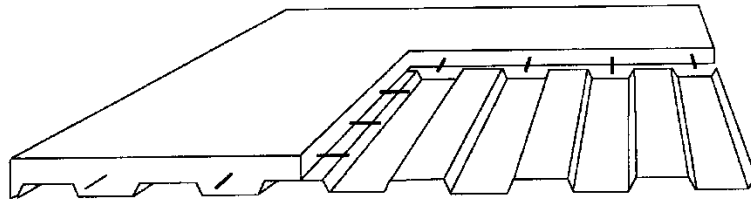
Losa de concreto con refuerzo de lámina corrugada.
